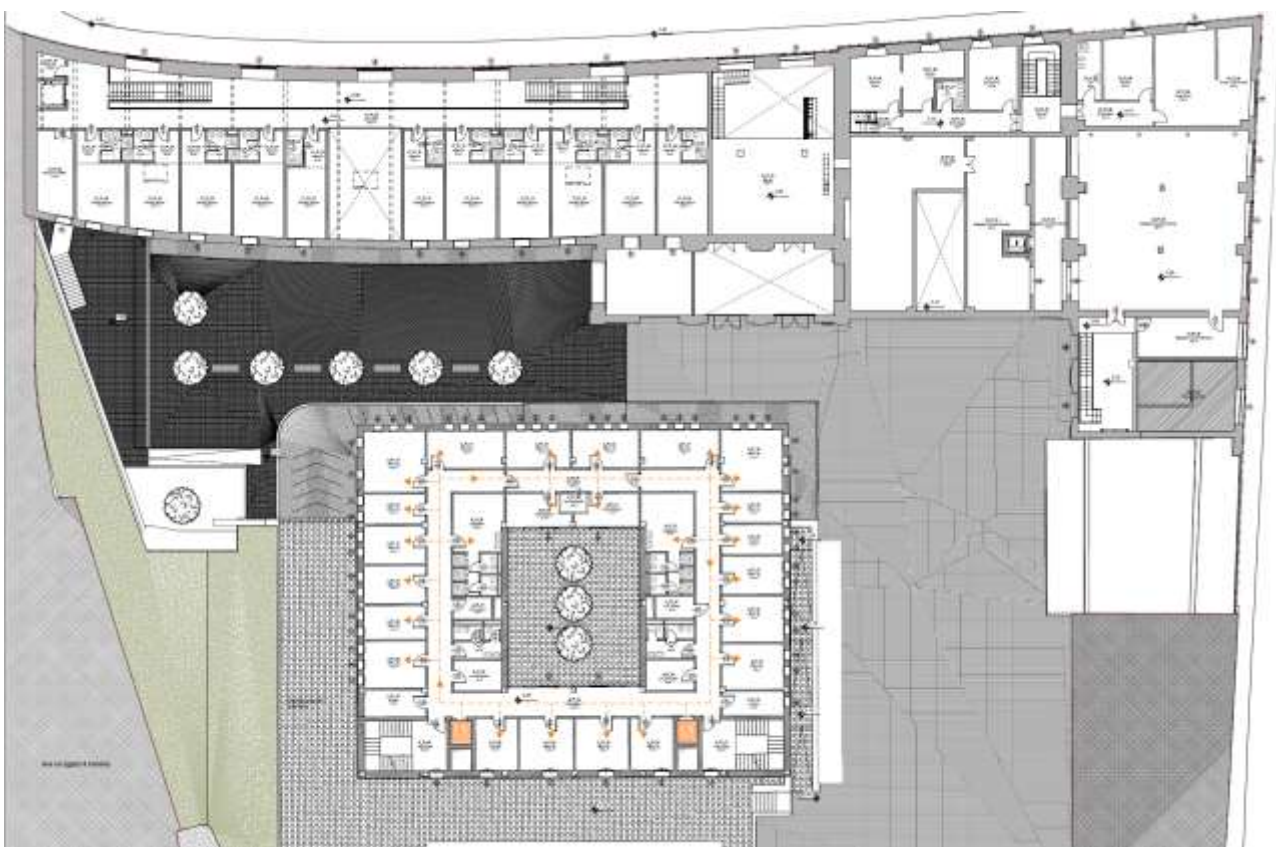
pianta piano primo - estratto della tavola dedicata al superamento delle barriere architettoniche
